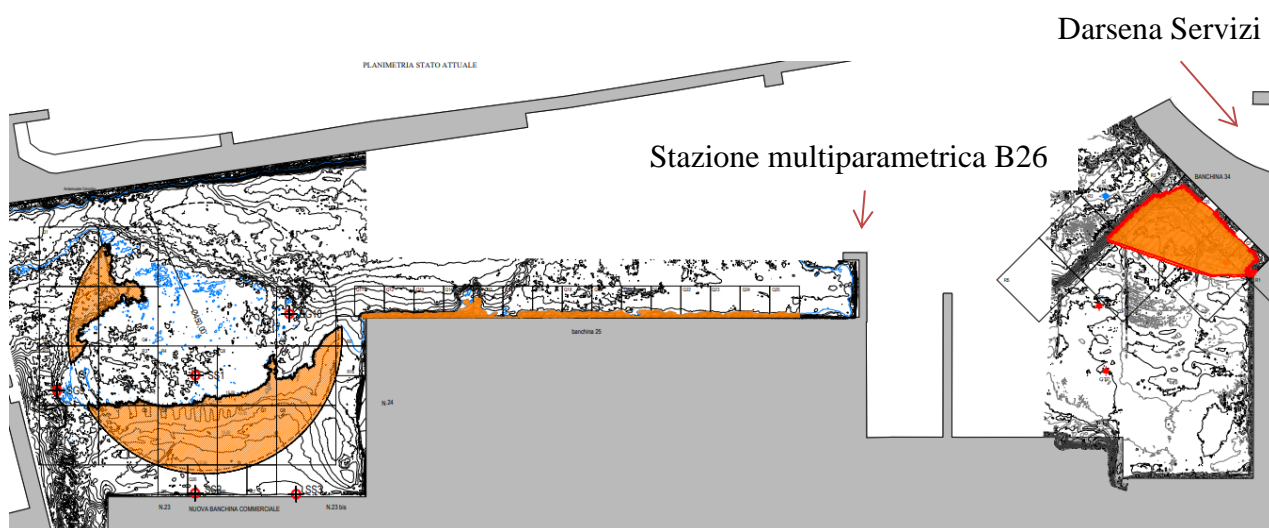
Stralcio planimetrico del Porto di Civitavecchia; banchina 26
